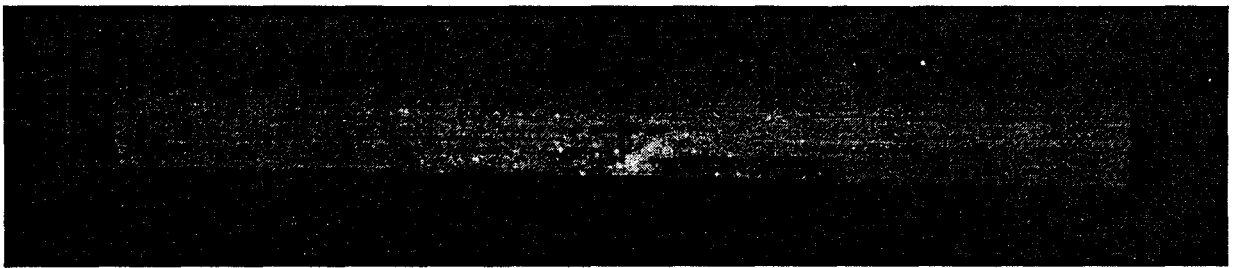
Double fissuration de l'éprouvette T25 ($f_a = 0,8$ mm)
